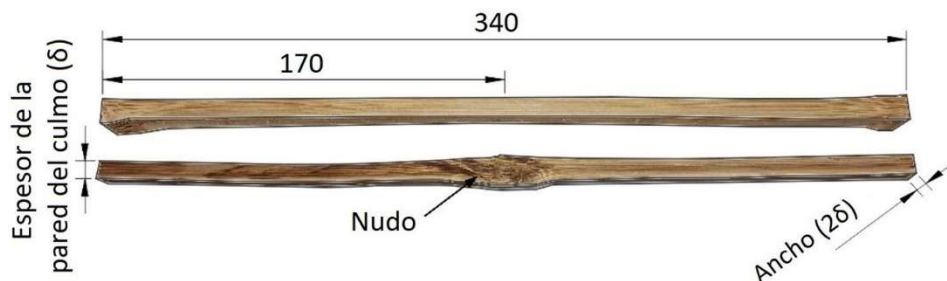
Dimensiones (en mm) de las probetas del ensayo de flexión en 4 puntos.
